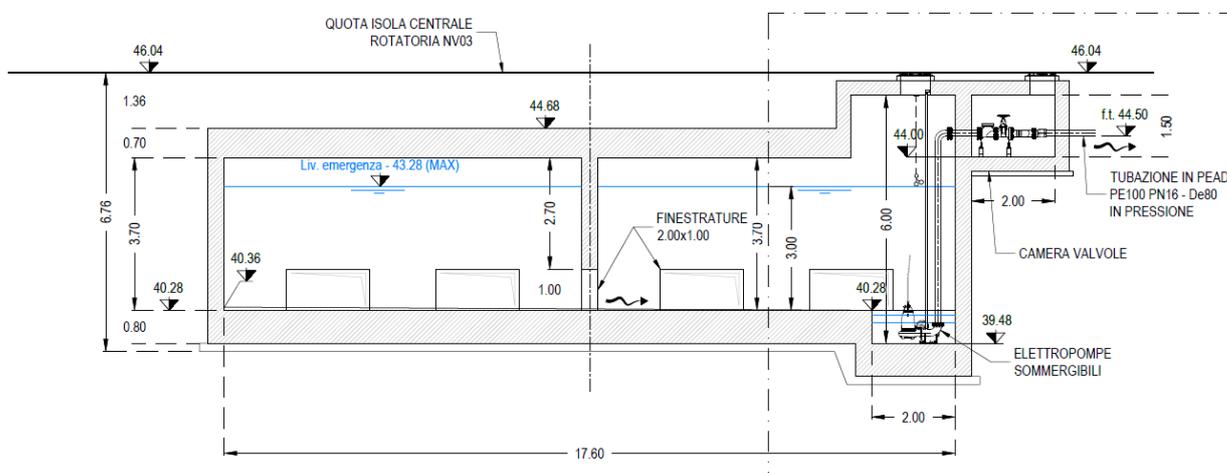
Sezione longitudinale vasca di laminazione e sollevamento
